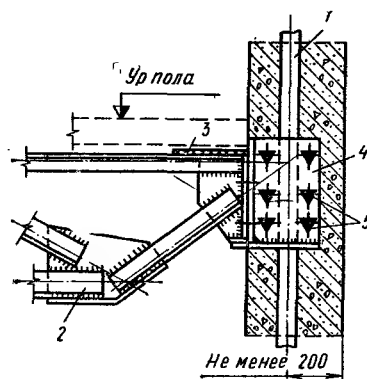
Узел крепления несущей конструкции междуэтажного перекрытия к подвеске
